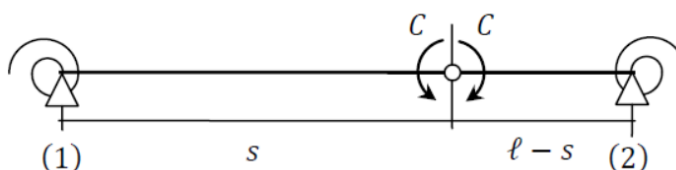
Rotule introduite dans une travée courante isolée d'une poutre continue
